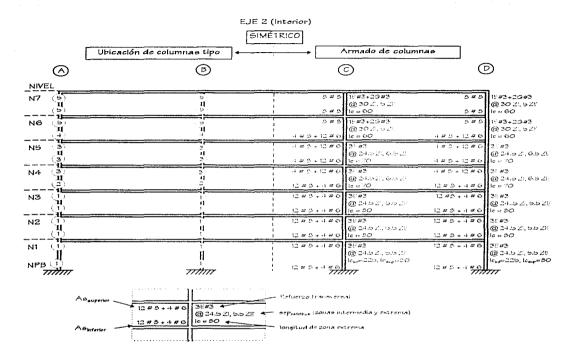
Uticación de los tipos de armados de las columnas del eje 2 de la estructura diseñada en la zona il!
